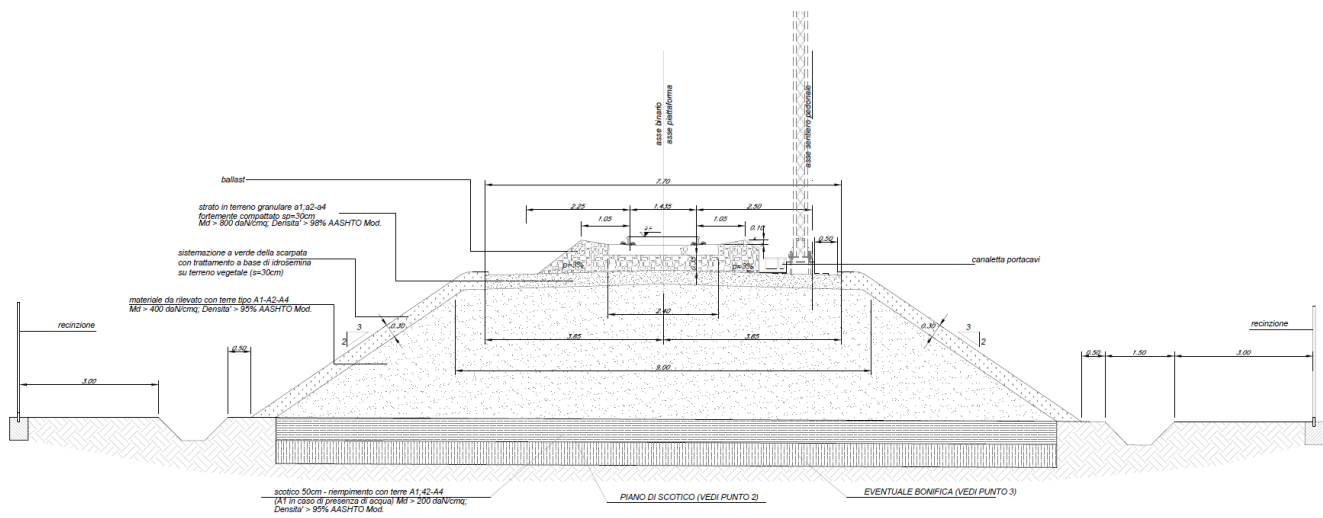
Sezione tipo in rilevato; Variante Provvisoria alla Linea Storica
